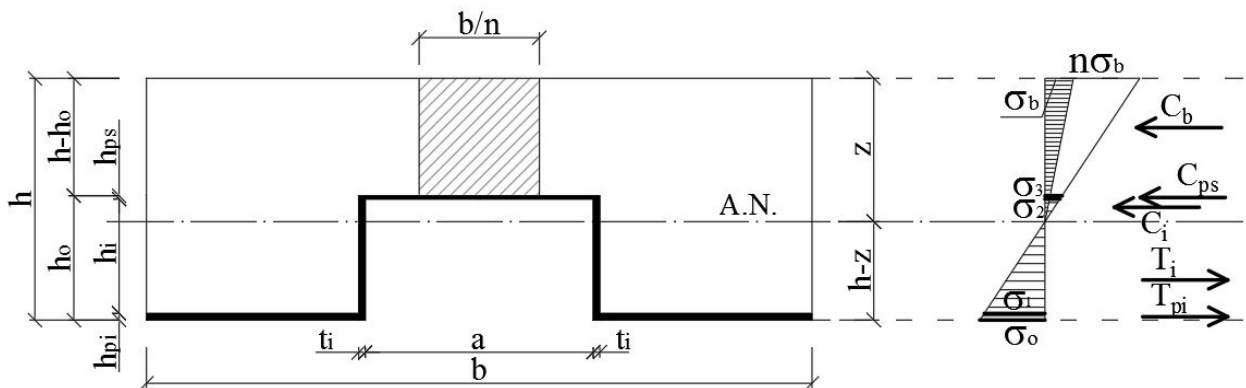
1. Model de calcul pentru structură mixtă oțel-beton tip dală cutată
